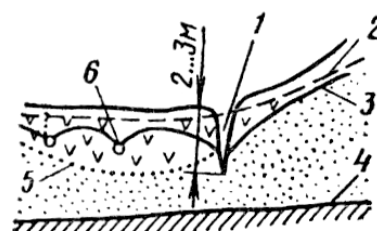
Перехват потока грунтовых вод ловчим каналом и дренажами: 1 – ловчий канал; 2 – уровень грунтовых вод до осушения; 3 – то же после осушения; 4 – водопупор; 5 – подошва торфяника; 6 – дрены
